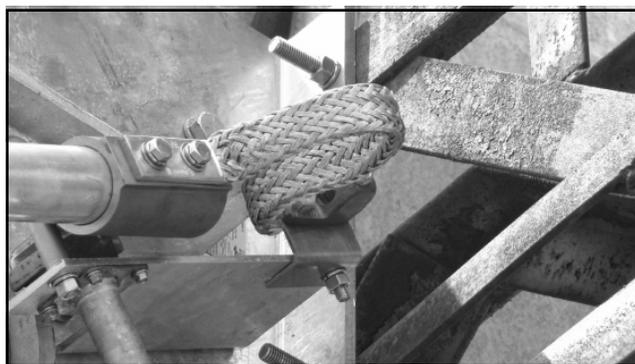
D. Ensamblaje de la cuchilla de puesta a tierra: soguilla, roldana plana, roldana de presión y tornillo.
